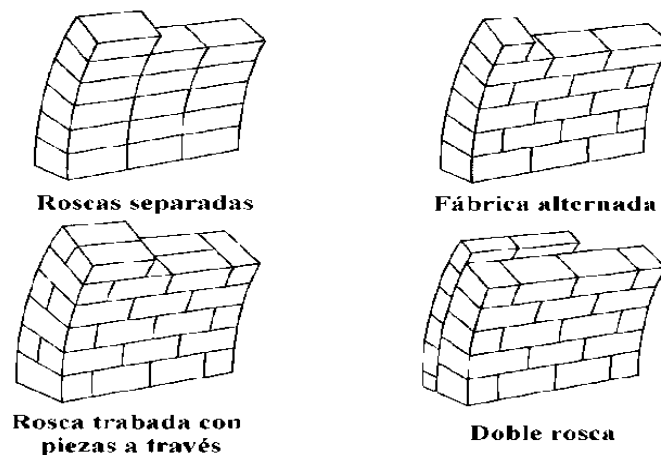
Tipos de aparejos en bóvedas de puentes de mampostería.
